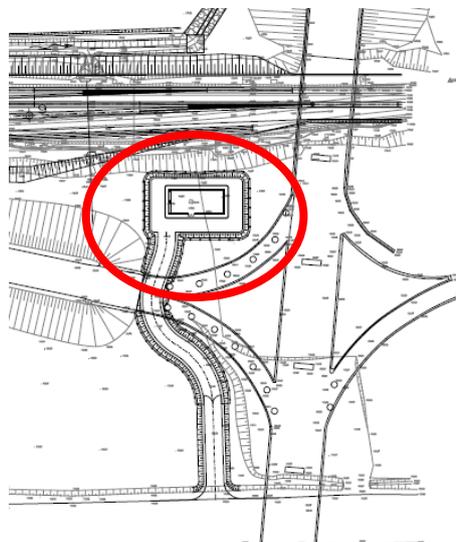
Cerchiata in rosso la localizzazione planimetrica del fabbricato
